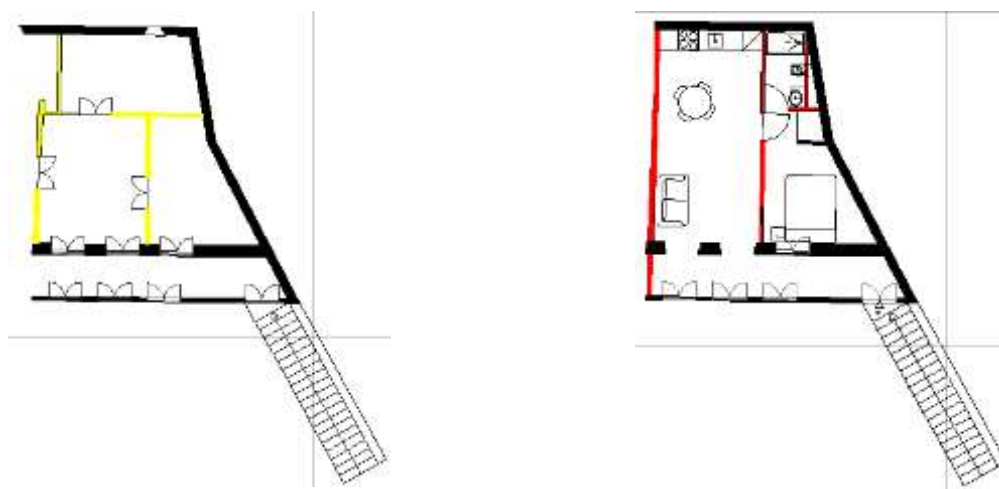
Planta da fração H antes (esquerda) e depois (direita) da intervenção
